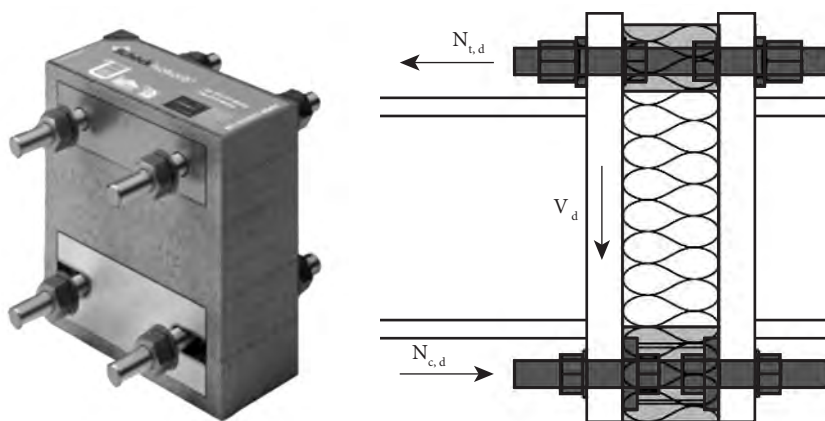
Теплоизоляционный вкладыш для крепления консолей к стальному каркасу
